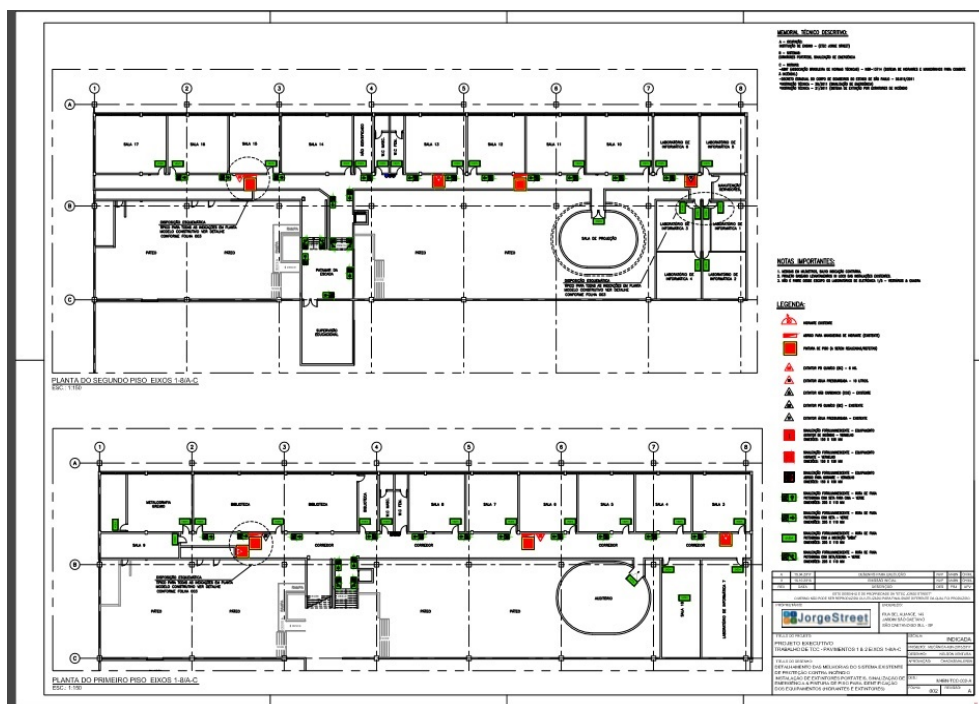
Planta do primeiro e segundo andar da ETEC JORGE STREET
